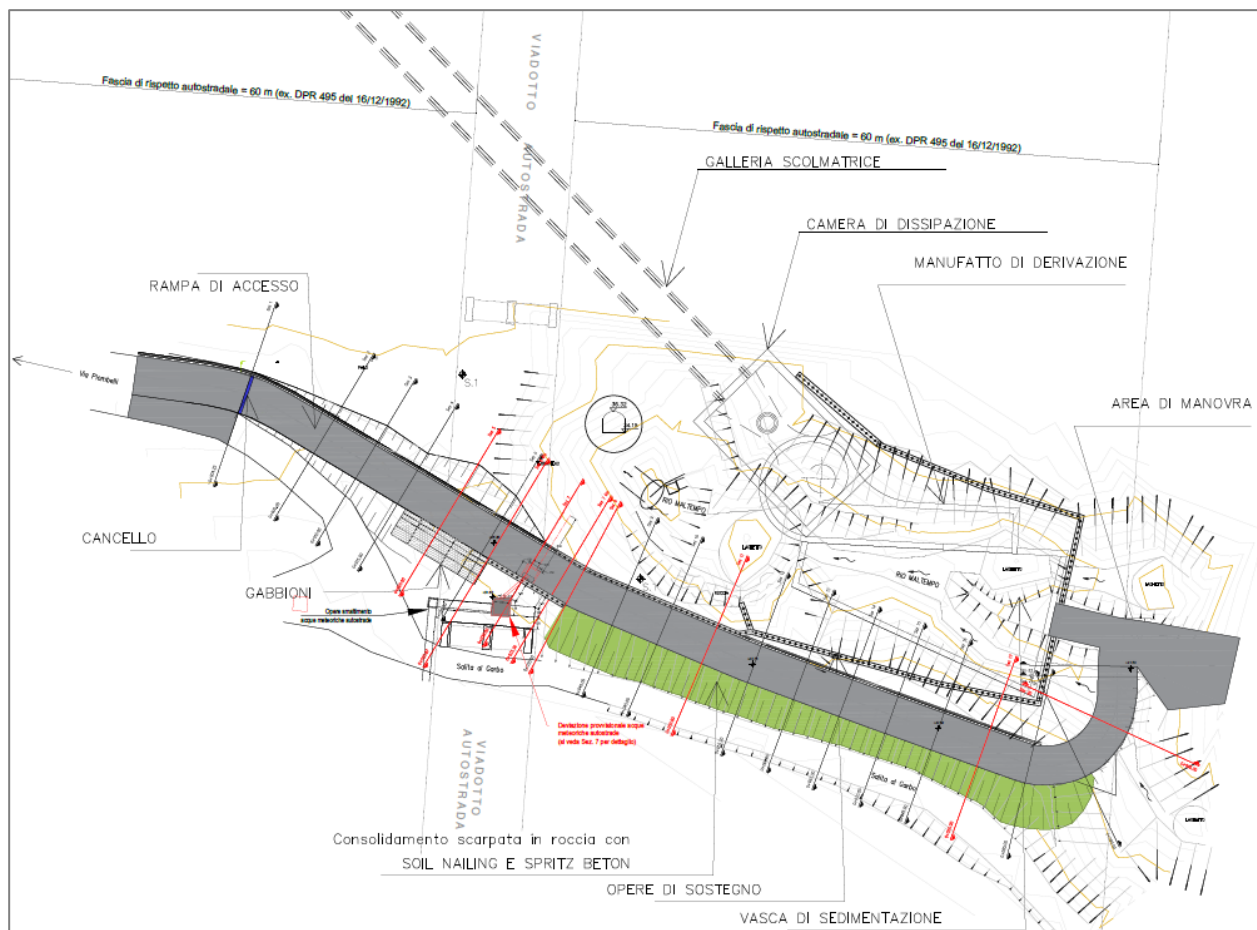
Estratto della planimetria generale della rampa di accesso all'opera di presa
